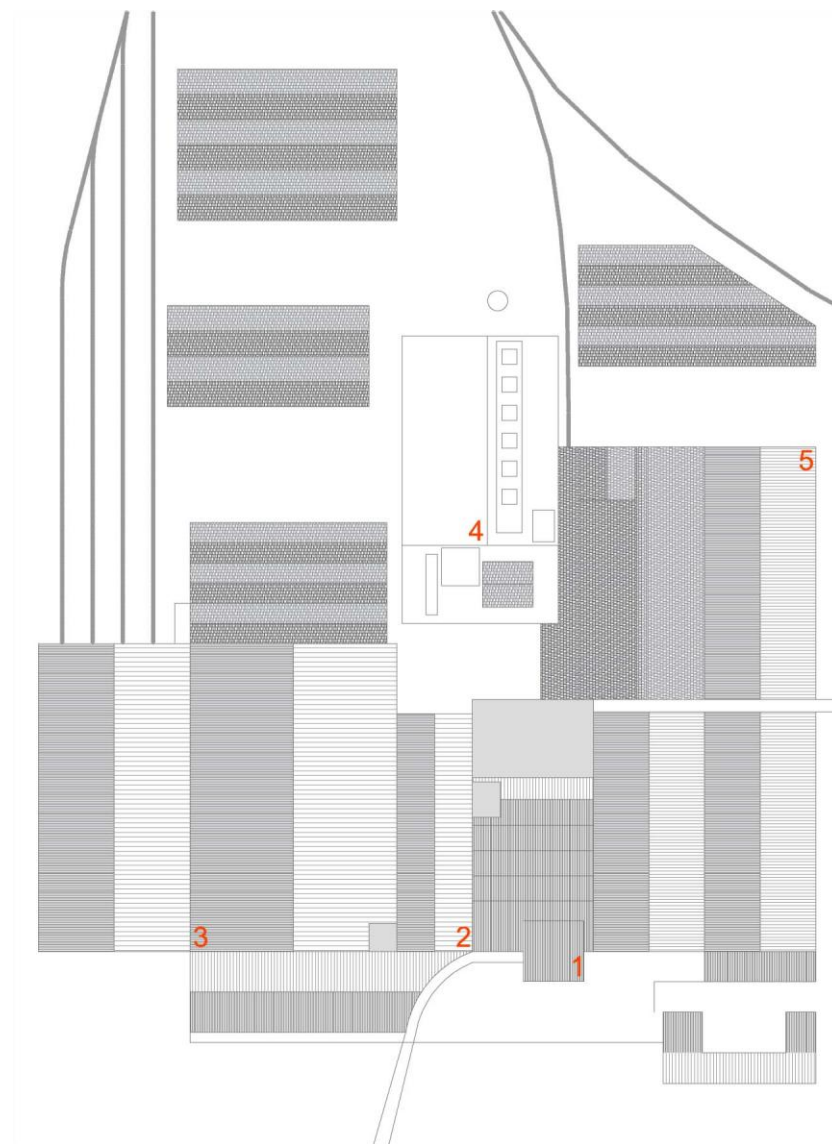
Setor oeste, Planta da década de 1940. Escala: 1:1.500. Fonte: Autor.
